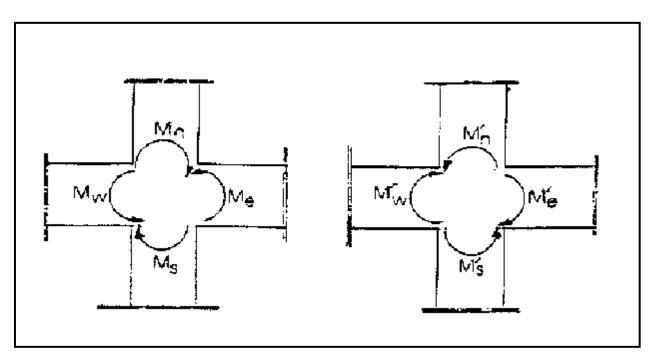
Dimensionnement d'un nœud poutre-poteau
